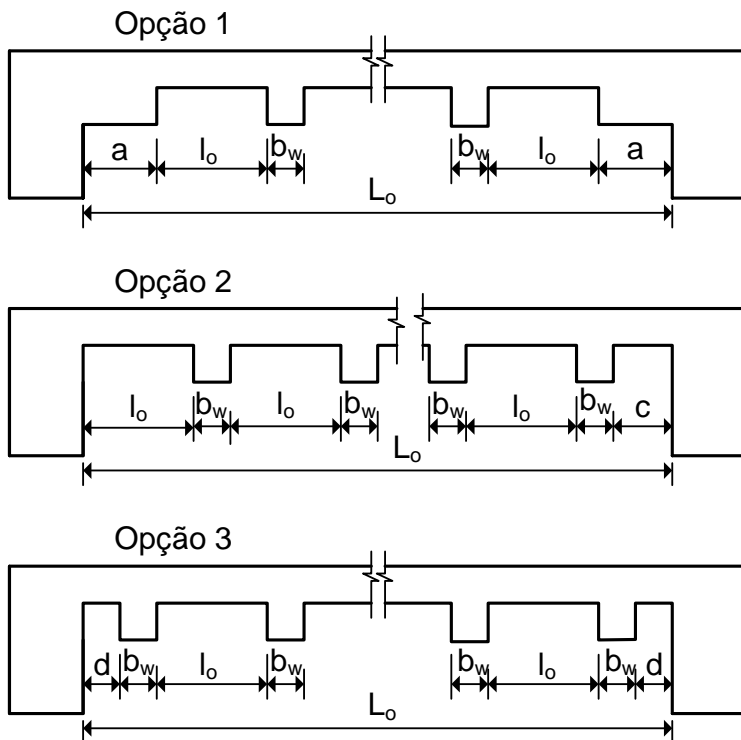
Alternativas para a disposição das nervuras
